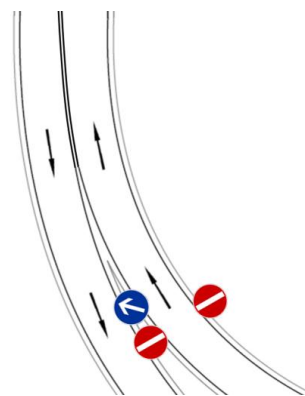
Exemplanische Darstellung der Markierung und Beschilderung im Rampenbereich von Anschlussstellen (Planzeichnung: Anders / Schmidt)
